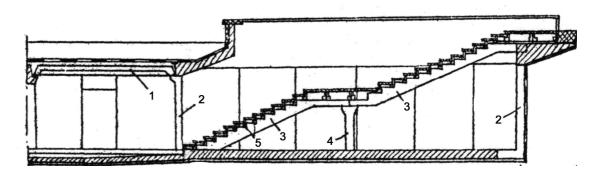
Сечение 2-2. 1 – плита перекрытия; 2 – стеновые блоки; 3 – сборный железобетонный косоур; 4 – стойка; 5 – гранитные подступенки
